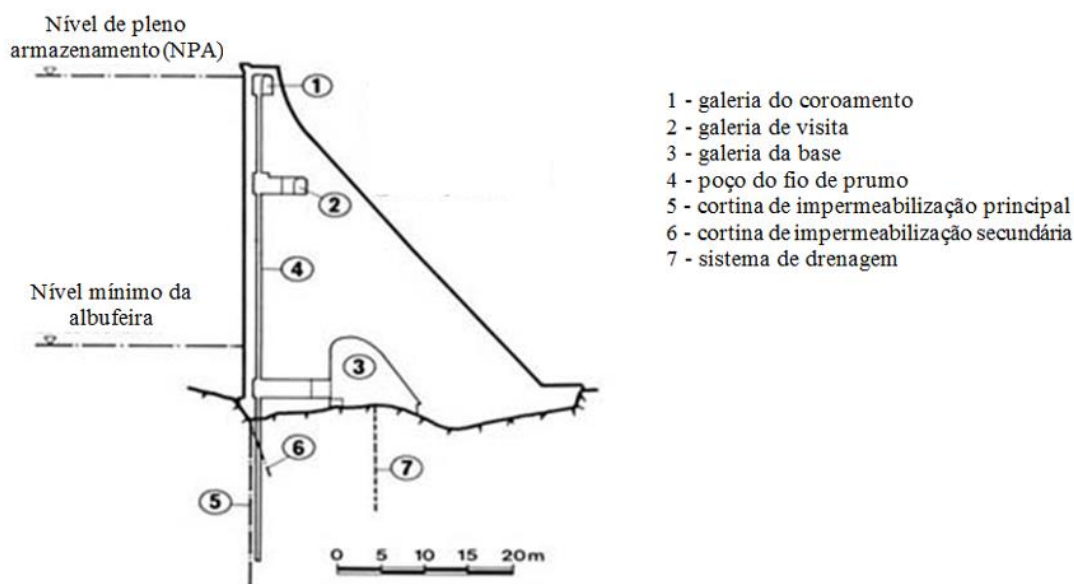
Perfil de uma barragem gravidade, com indicação da localização da cortina de impermeabilização e do sistema de drenagem (adaptado de ICOLD 2019).
